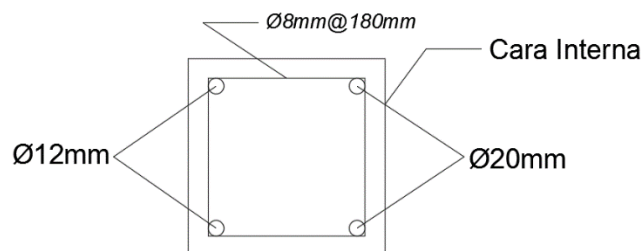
Vista en planta de la sección trasversal del poste de hormigón armado. Realizado por: Autor
